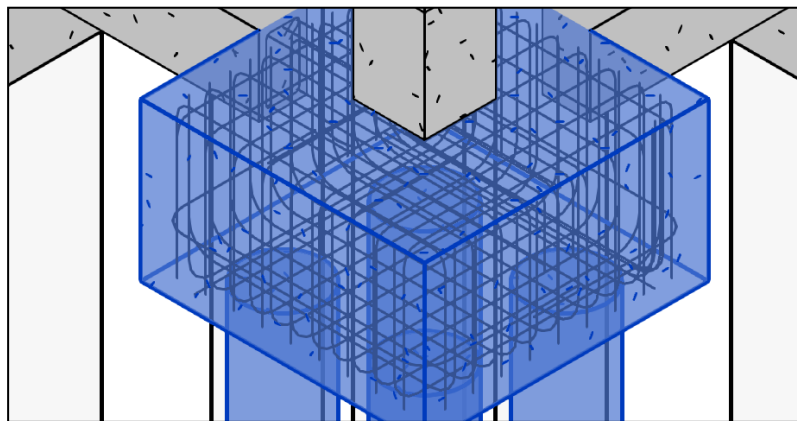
Vista del refuerzo de los cabezales de la cimentación
